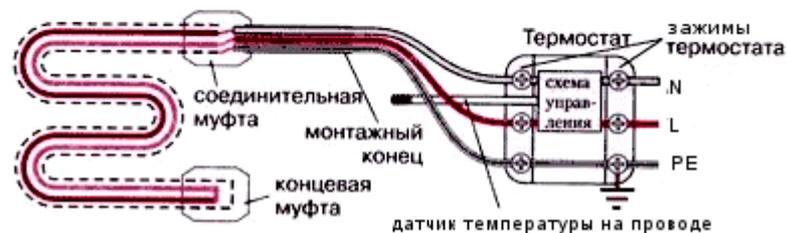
Схема укладки кабельной нагревательной секции в помещении
